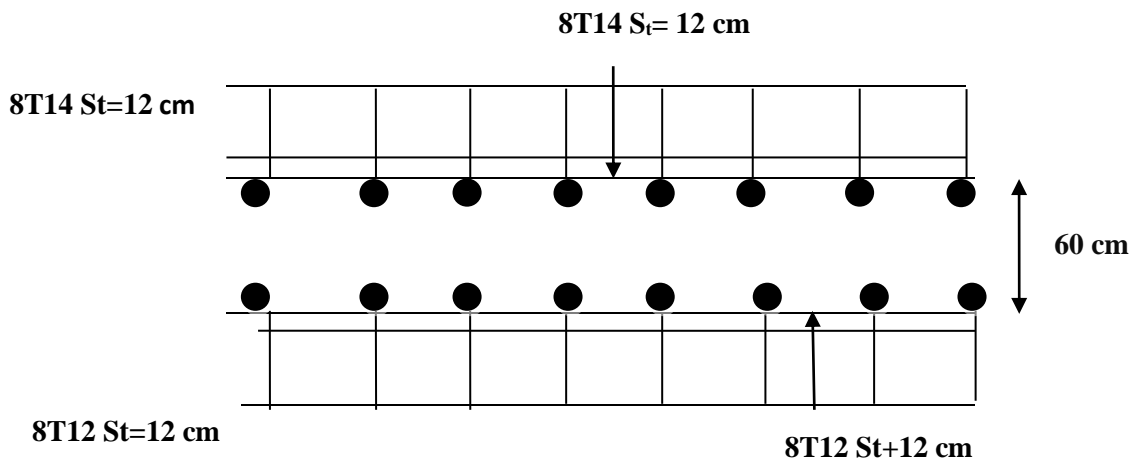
Ferrailage de la dalle du radier en travée et appuis.
